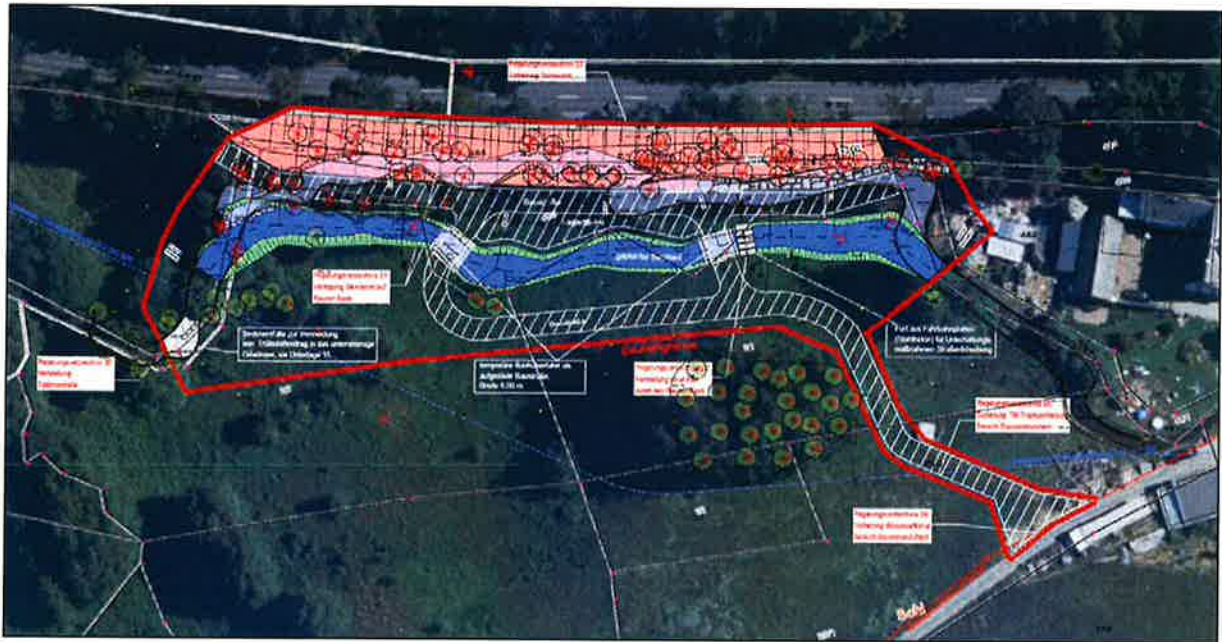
Ausschnitt Lageplan Baubereich (rot markiert) mit Baustraße (grau schraffiert) ( aus Anlage 5.1, [LAS-21])
